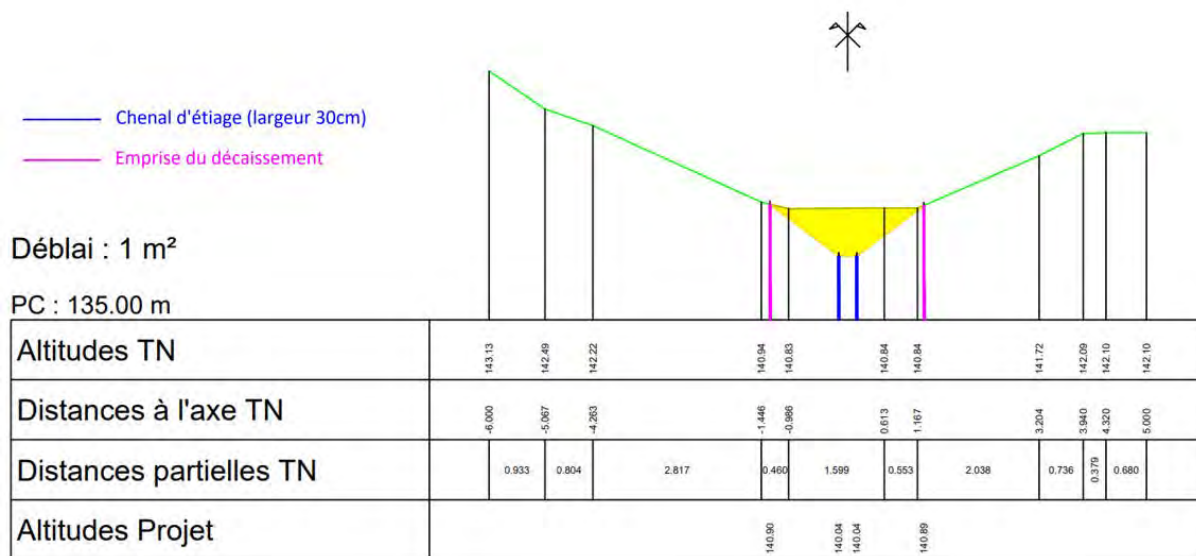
Exemple d'intervention pour un profil en travers de la Patouse
